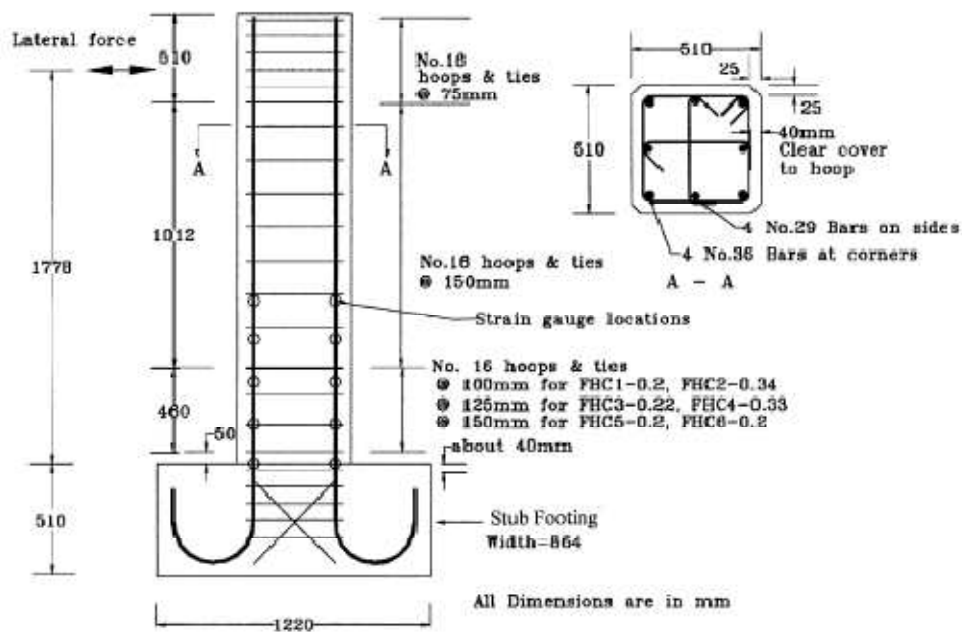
Armatura longitudinale e trasversale dei vari pilastri testati.
